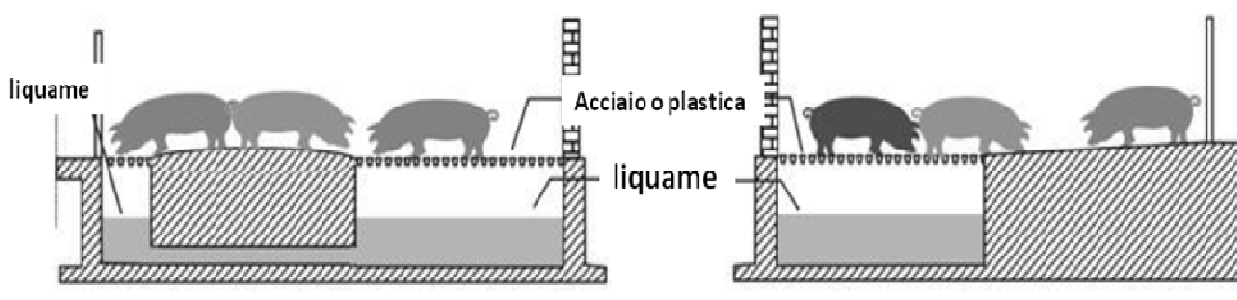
Pavimentazione parzialmente fessurata con pavimento pieno concavo o pendente
